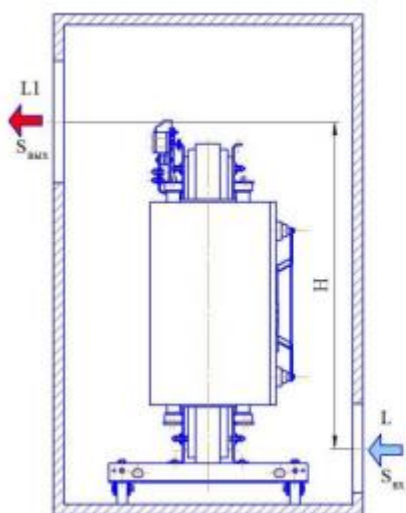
Габаритные и установочные размеры ТСЛ
